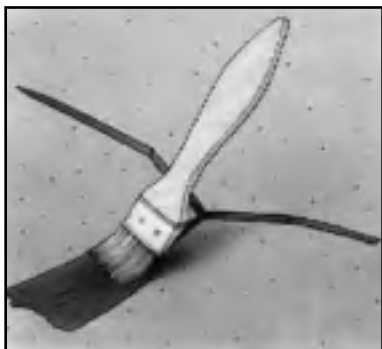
Обработка трещин грунтовкой Ceresit CT 17.
